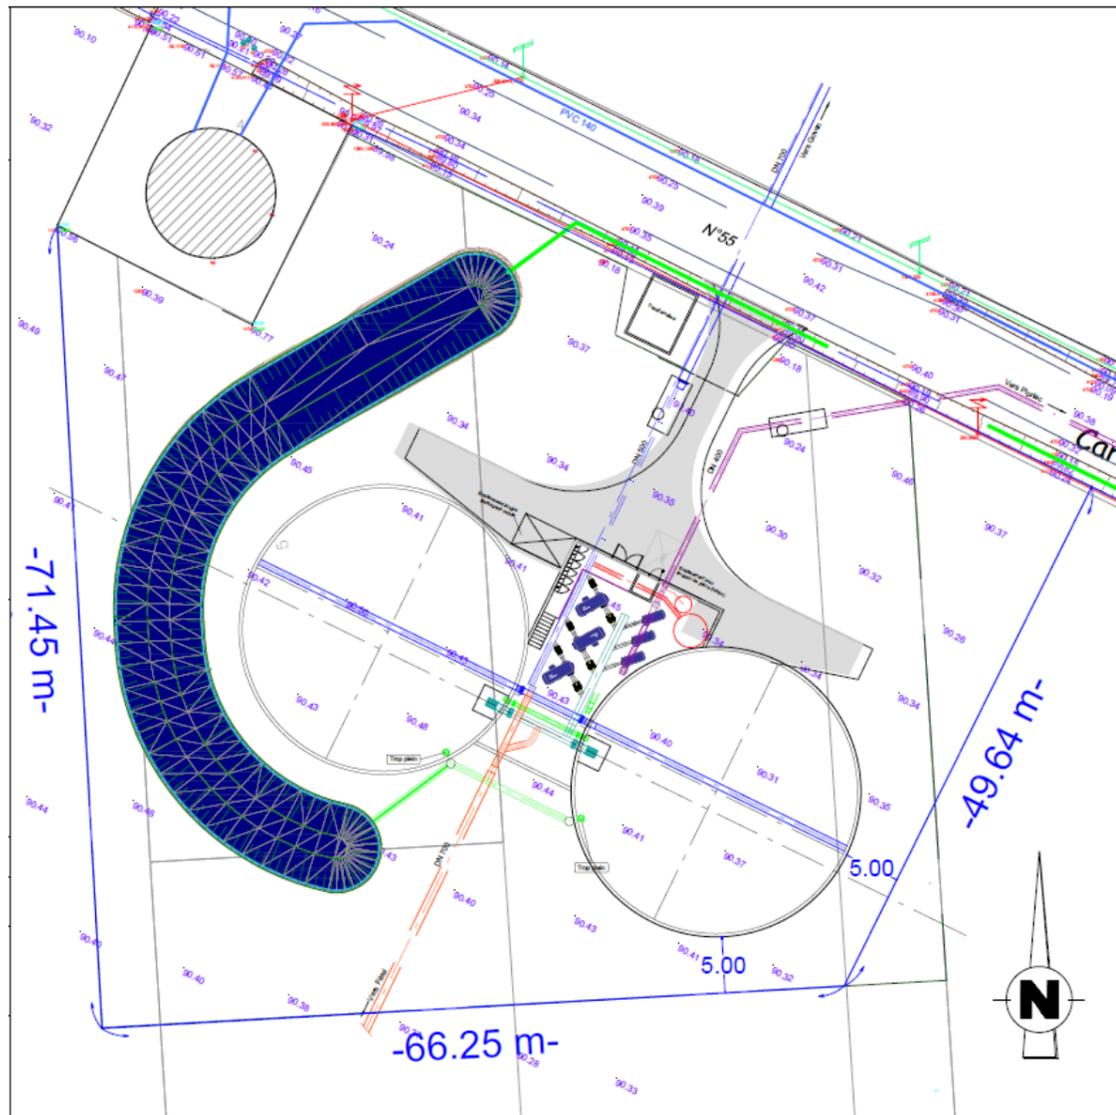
Plan de masse du projet - SIXT-SUR-AFF
